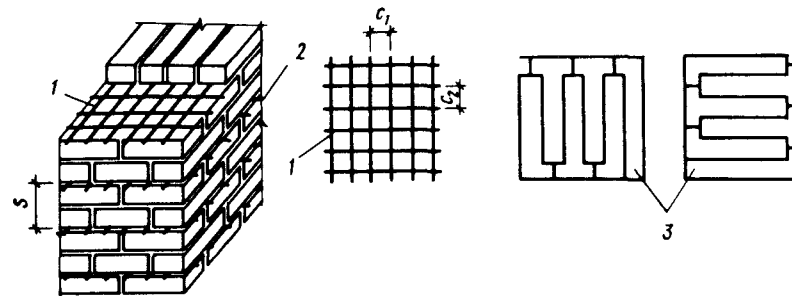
Сетчатое армирование каменных конструкций:
